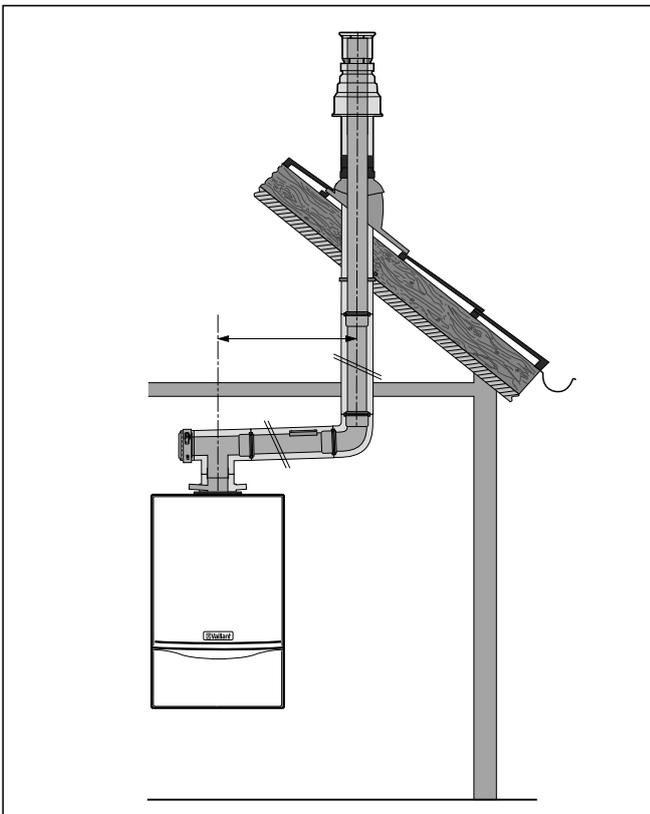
Montagebeispiel senkrechte Dachdurchführung
